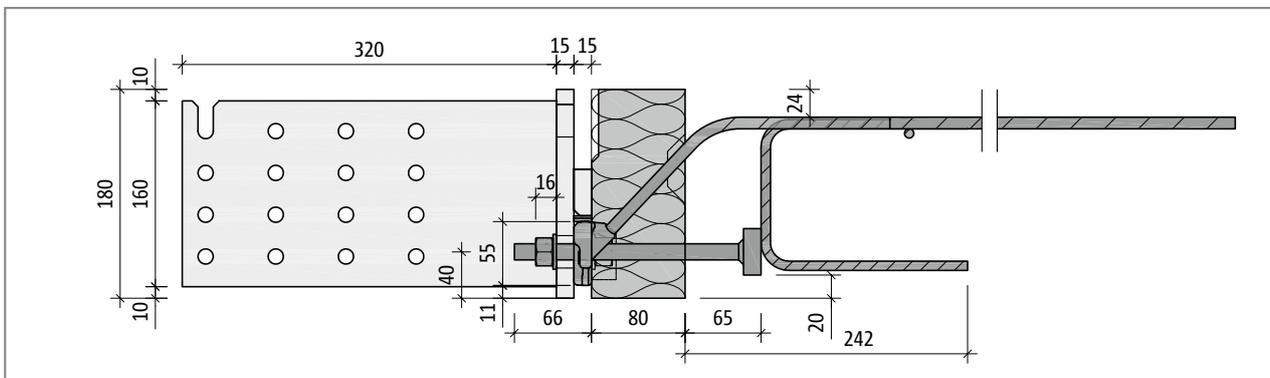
Schöck Isokorb® T Typ SQ mit Stahlschwert: Seitenansicht
